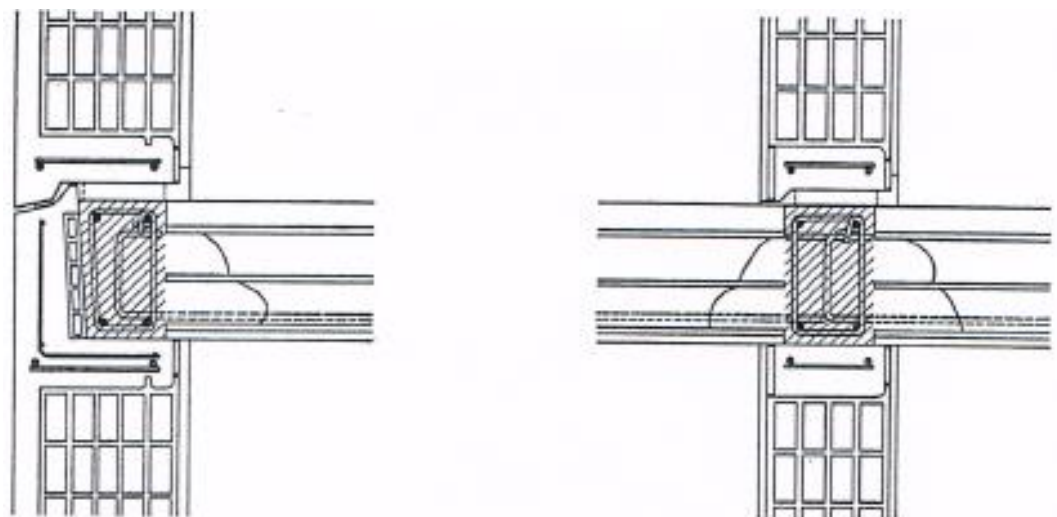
Pormenorização de cintas perpendiculares à armadura da laje (LNEC, 1968).
